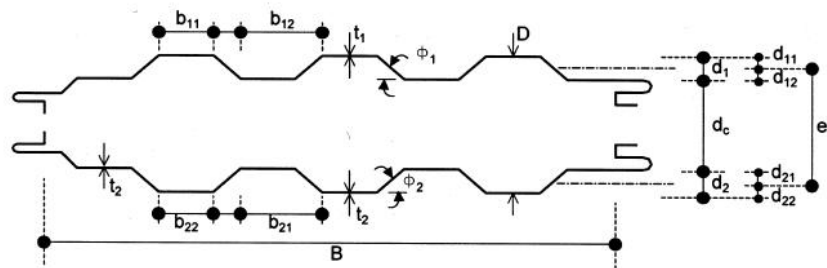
b) — Elementquerschnitt — profilierte Deckschicht und Werkstoffeigenschaftes Sandwichelements
